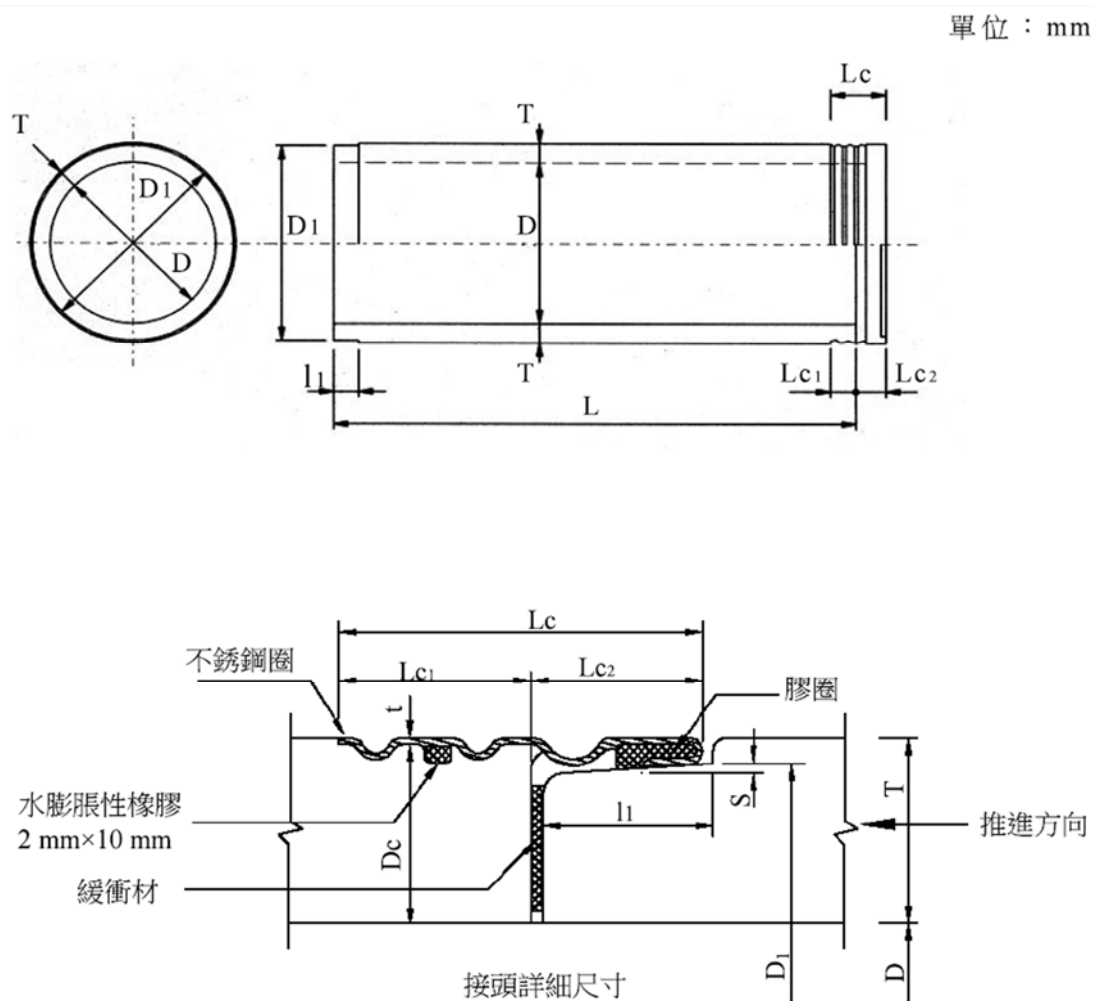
3S 接頭(鋼筋混凝土管)
